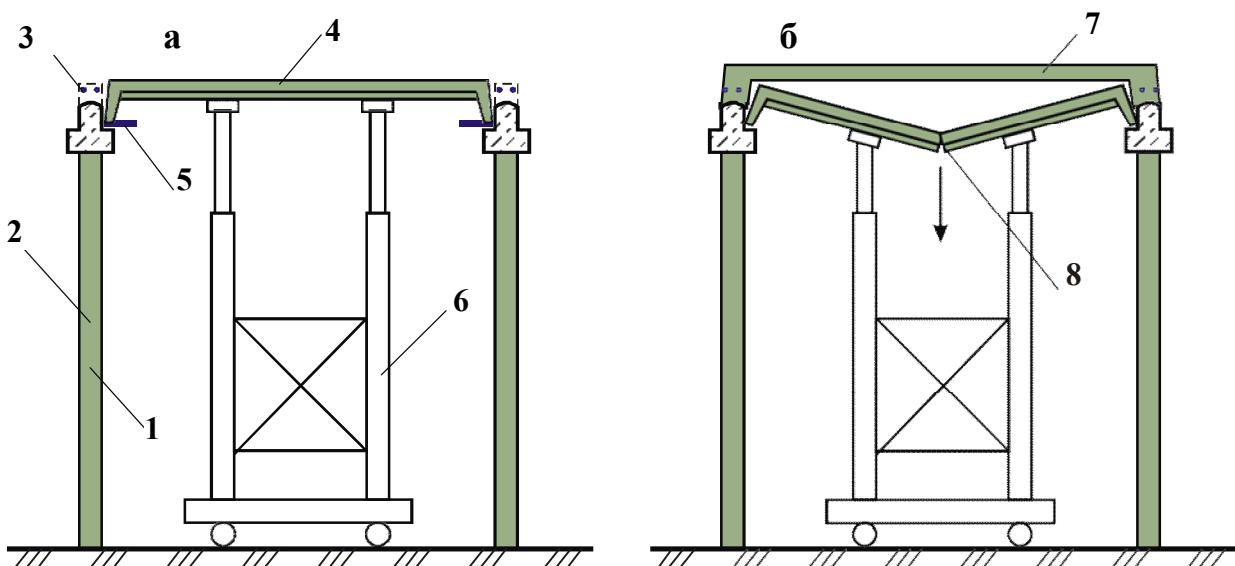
Заміна збірних залізобетонних плит перекриття:
